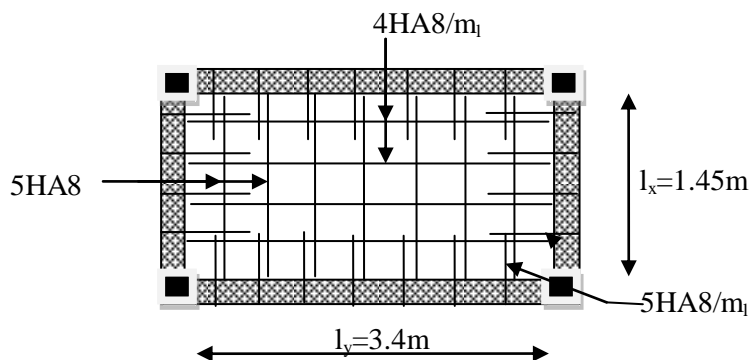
schéma de ferrailage de la dalle sur 4 appuis.
